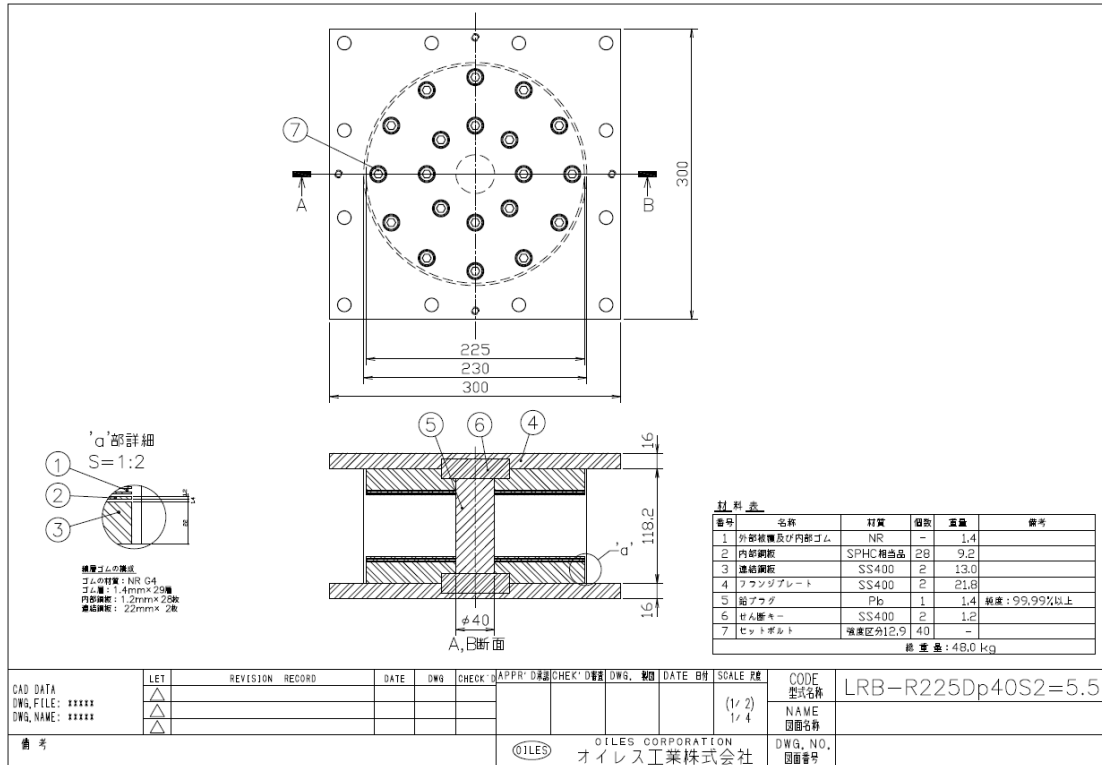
R1 試験体 (丸型断面, 鉛プラグ 1 本タイプ)
